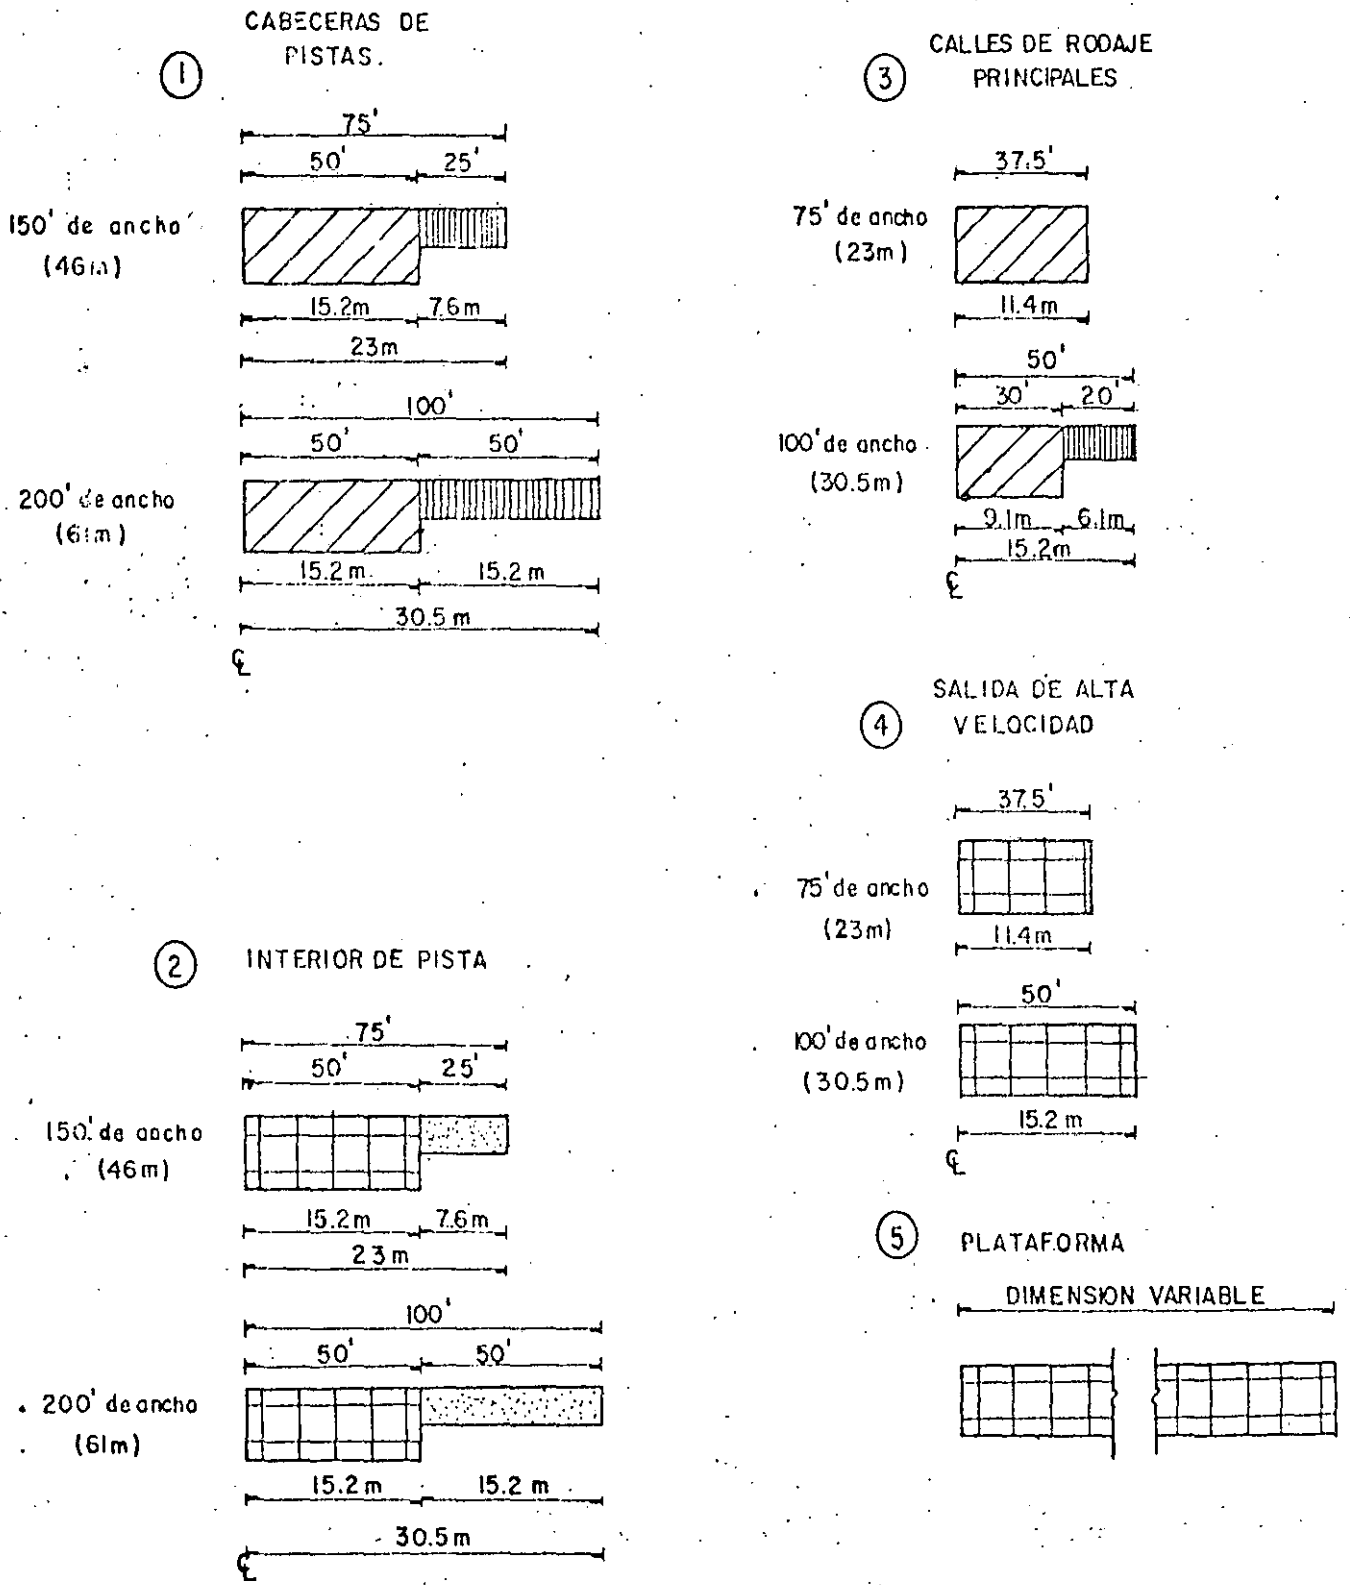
SECCIONES TRANSVERSALES DE PAVIMENTO. Instituto del Asfalto 1973)
